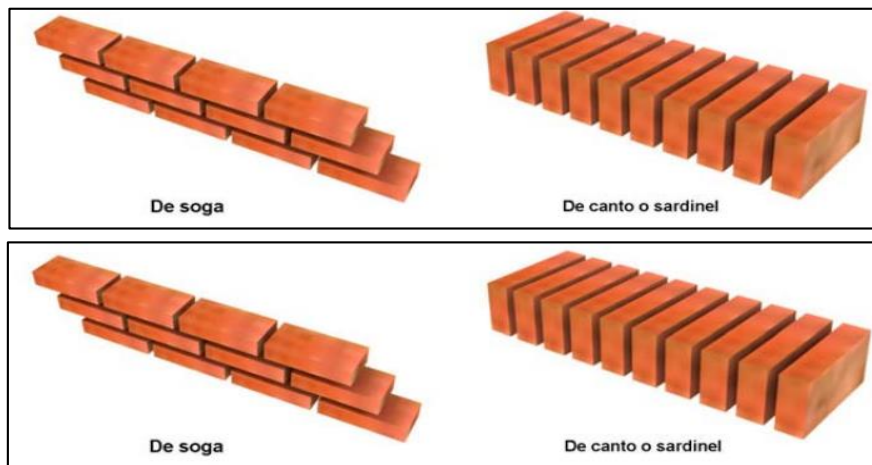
Tipos de aparejo según su colocación [Ilustración]
